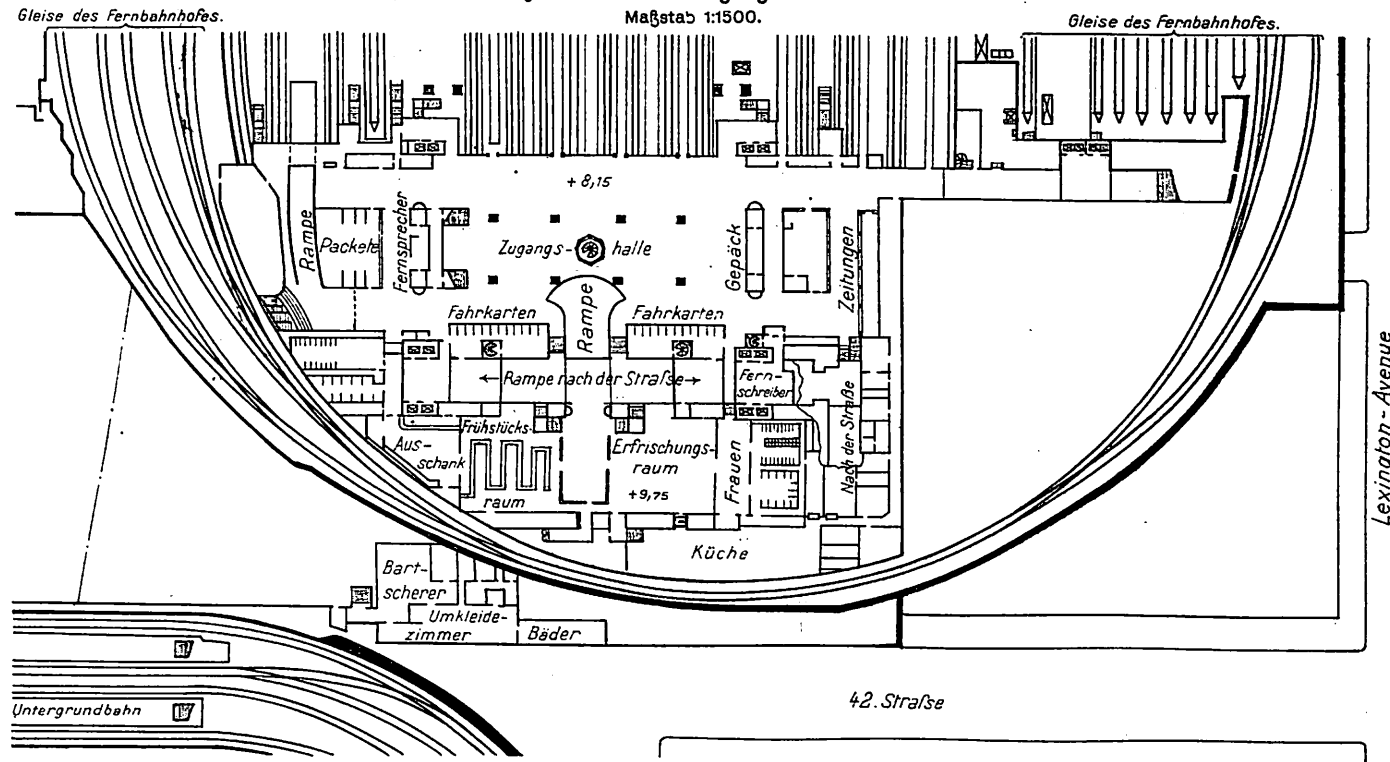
Grundriß in Höhe der Straße und des Gepäckraumes.
